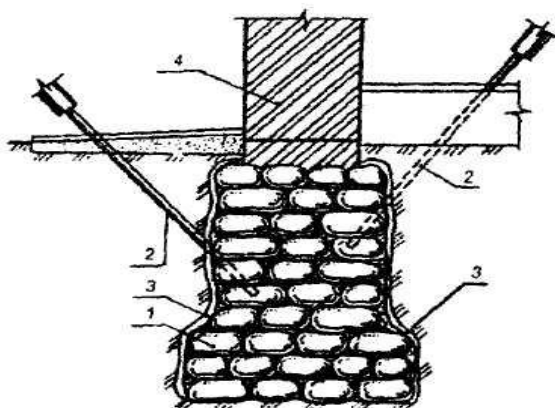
Закрепление бутовой кладки фундамента цементацией
